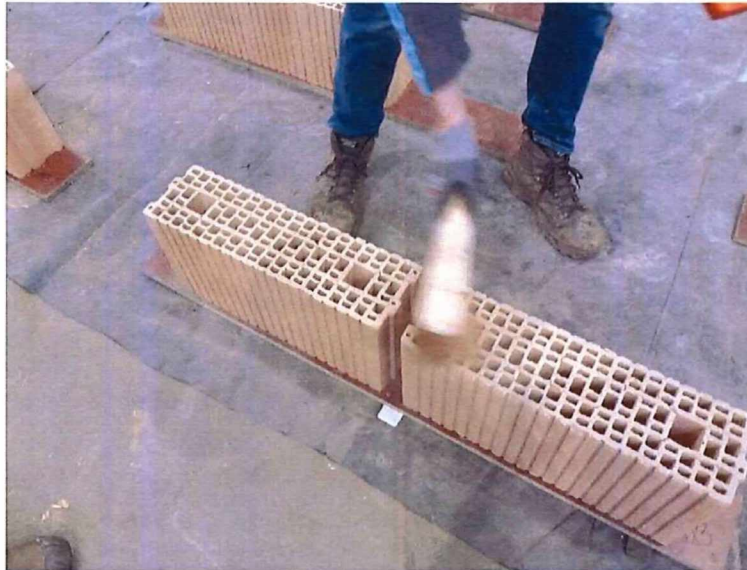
Brossage de chaque couche de pierres avant la pose de la suivante
